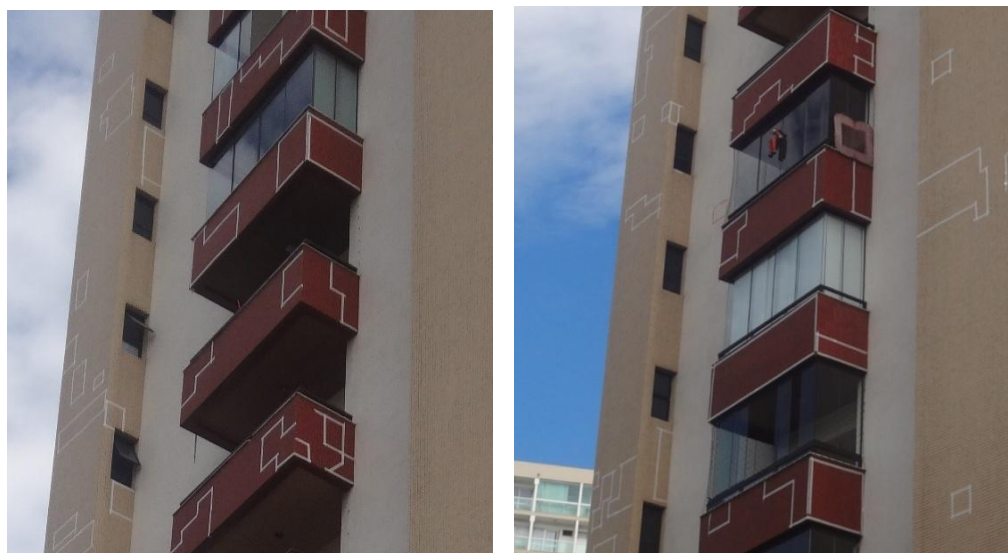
Fissuras na argamassa nos locais de desprendimento cerâmico
